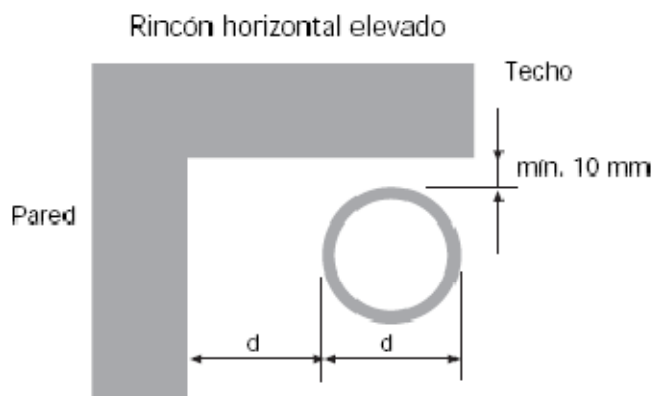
Distancia entre tubería de gas y rincón horizontal.
